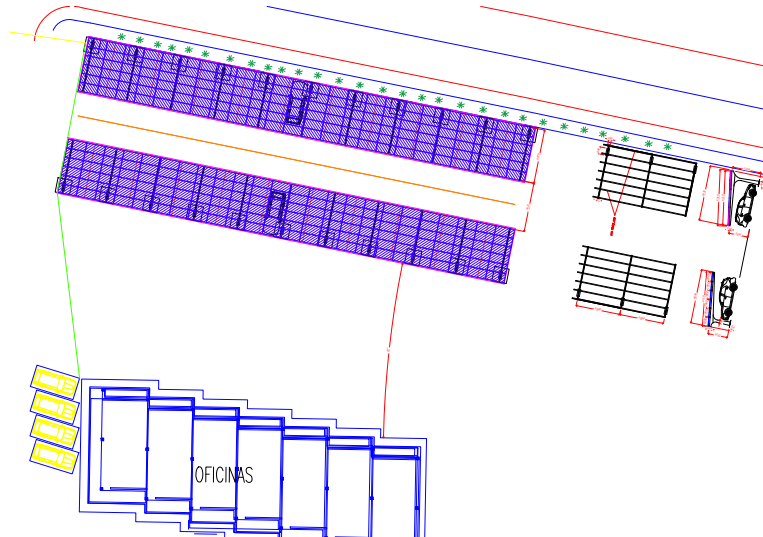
Plano del Aparcamiento desde Planta. Fuente: Galvessa.SA
